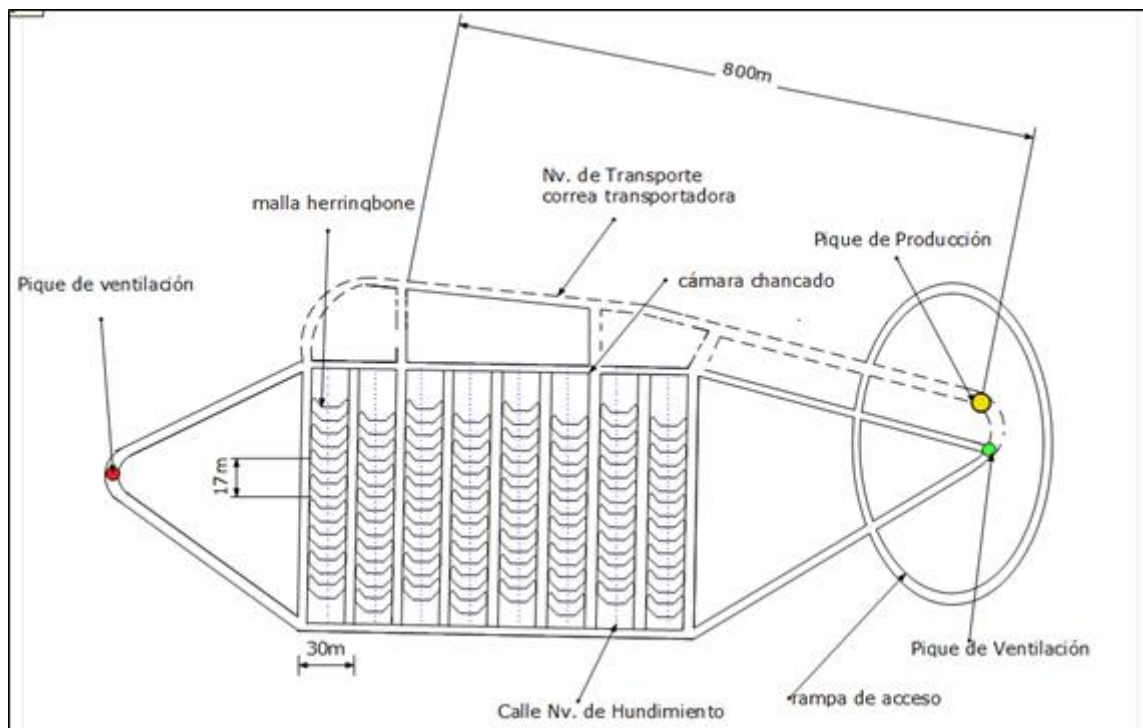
Vista en planta esquemática de una mina de Block/Panel Caving.
